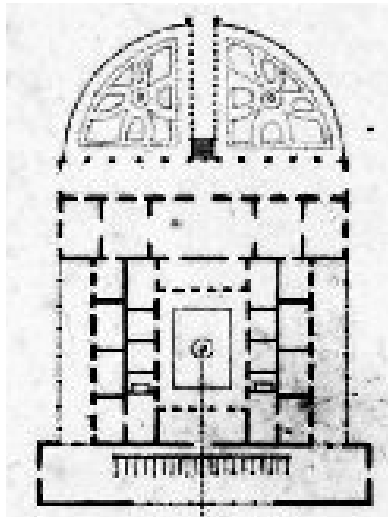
Vista en planta de la casa de vivienda del Ingenio Armonía. Fuente: (Cantero J., 2005)
